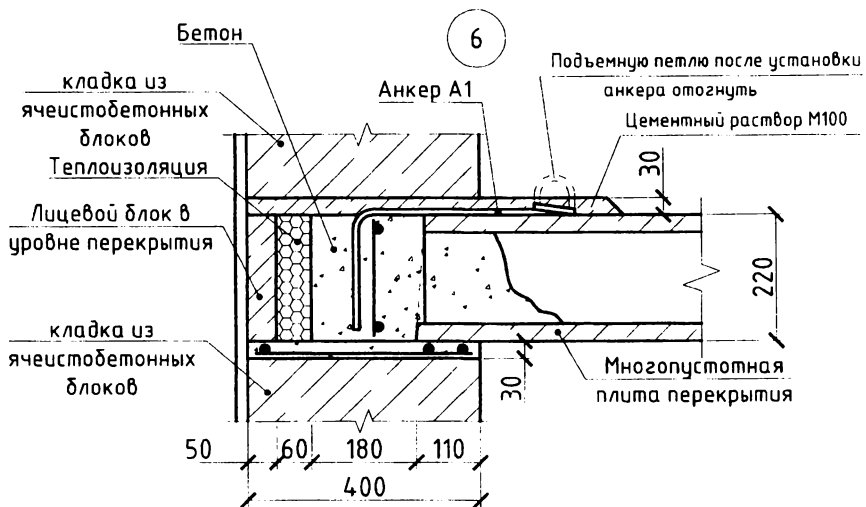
Узел опирания плиты перекрытия на стены из легбетонных блоков (смотреть совместно с рисунком 12)
